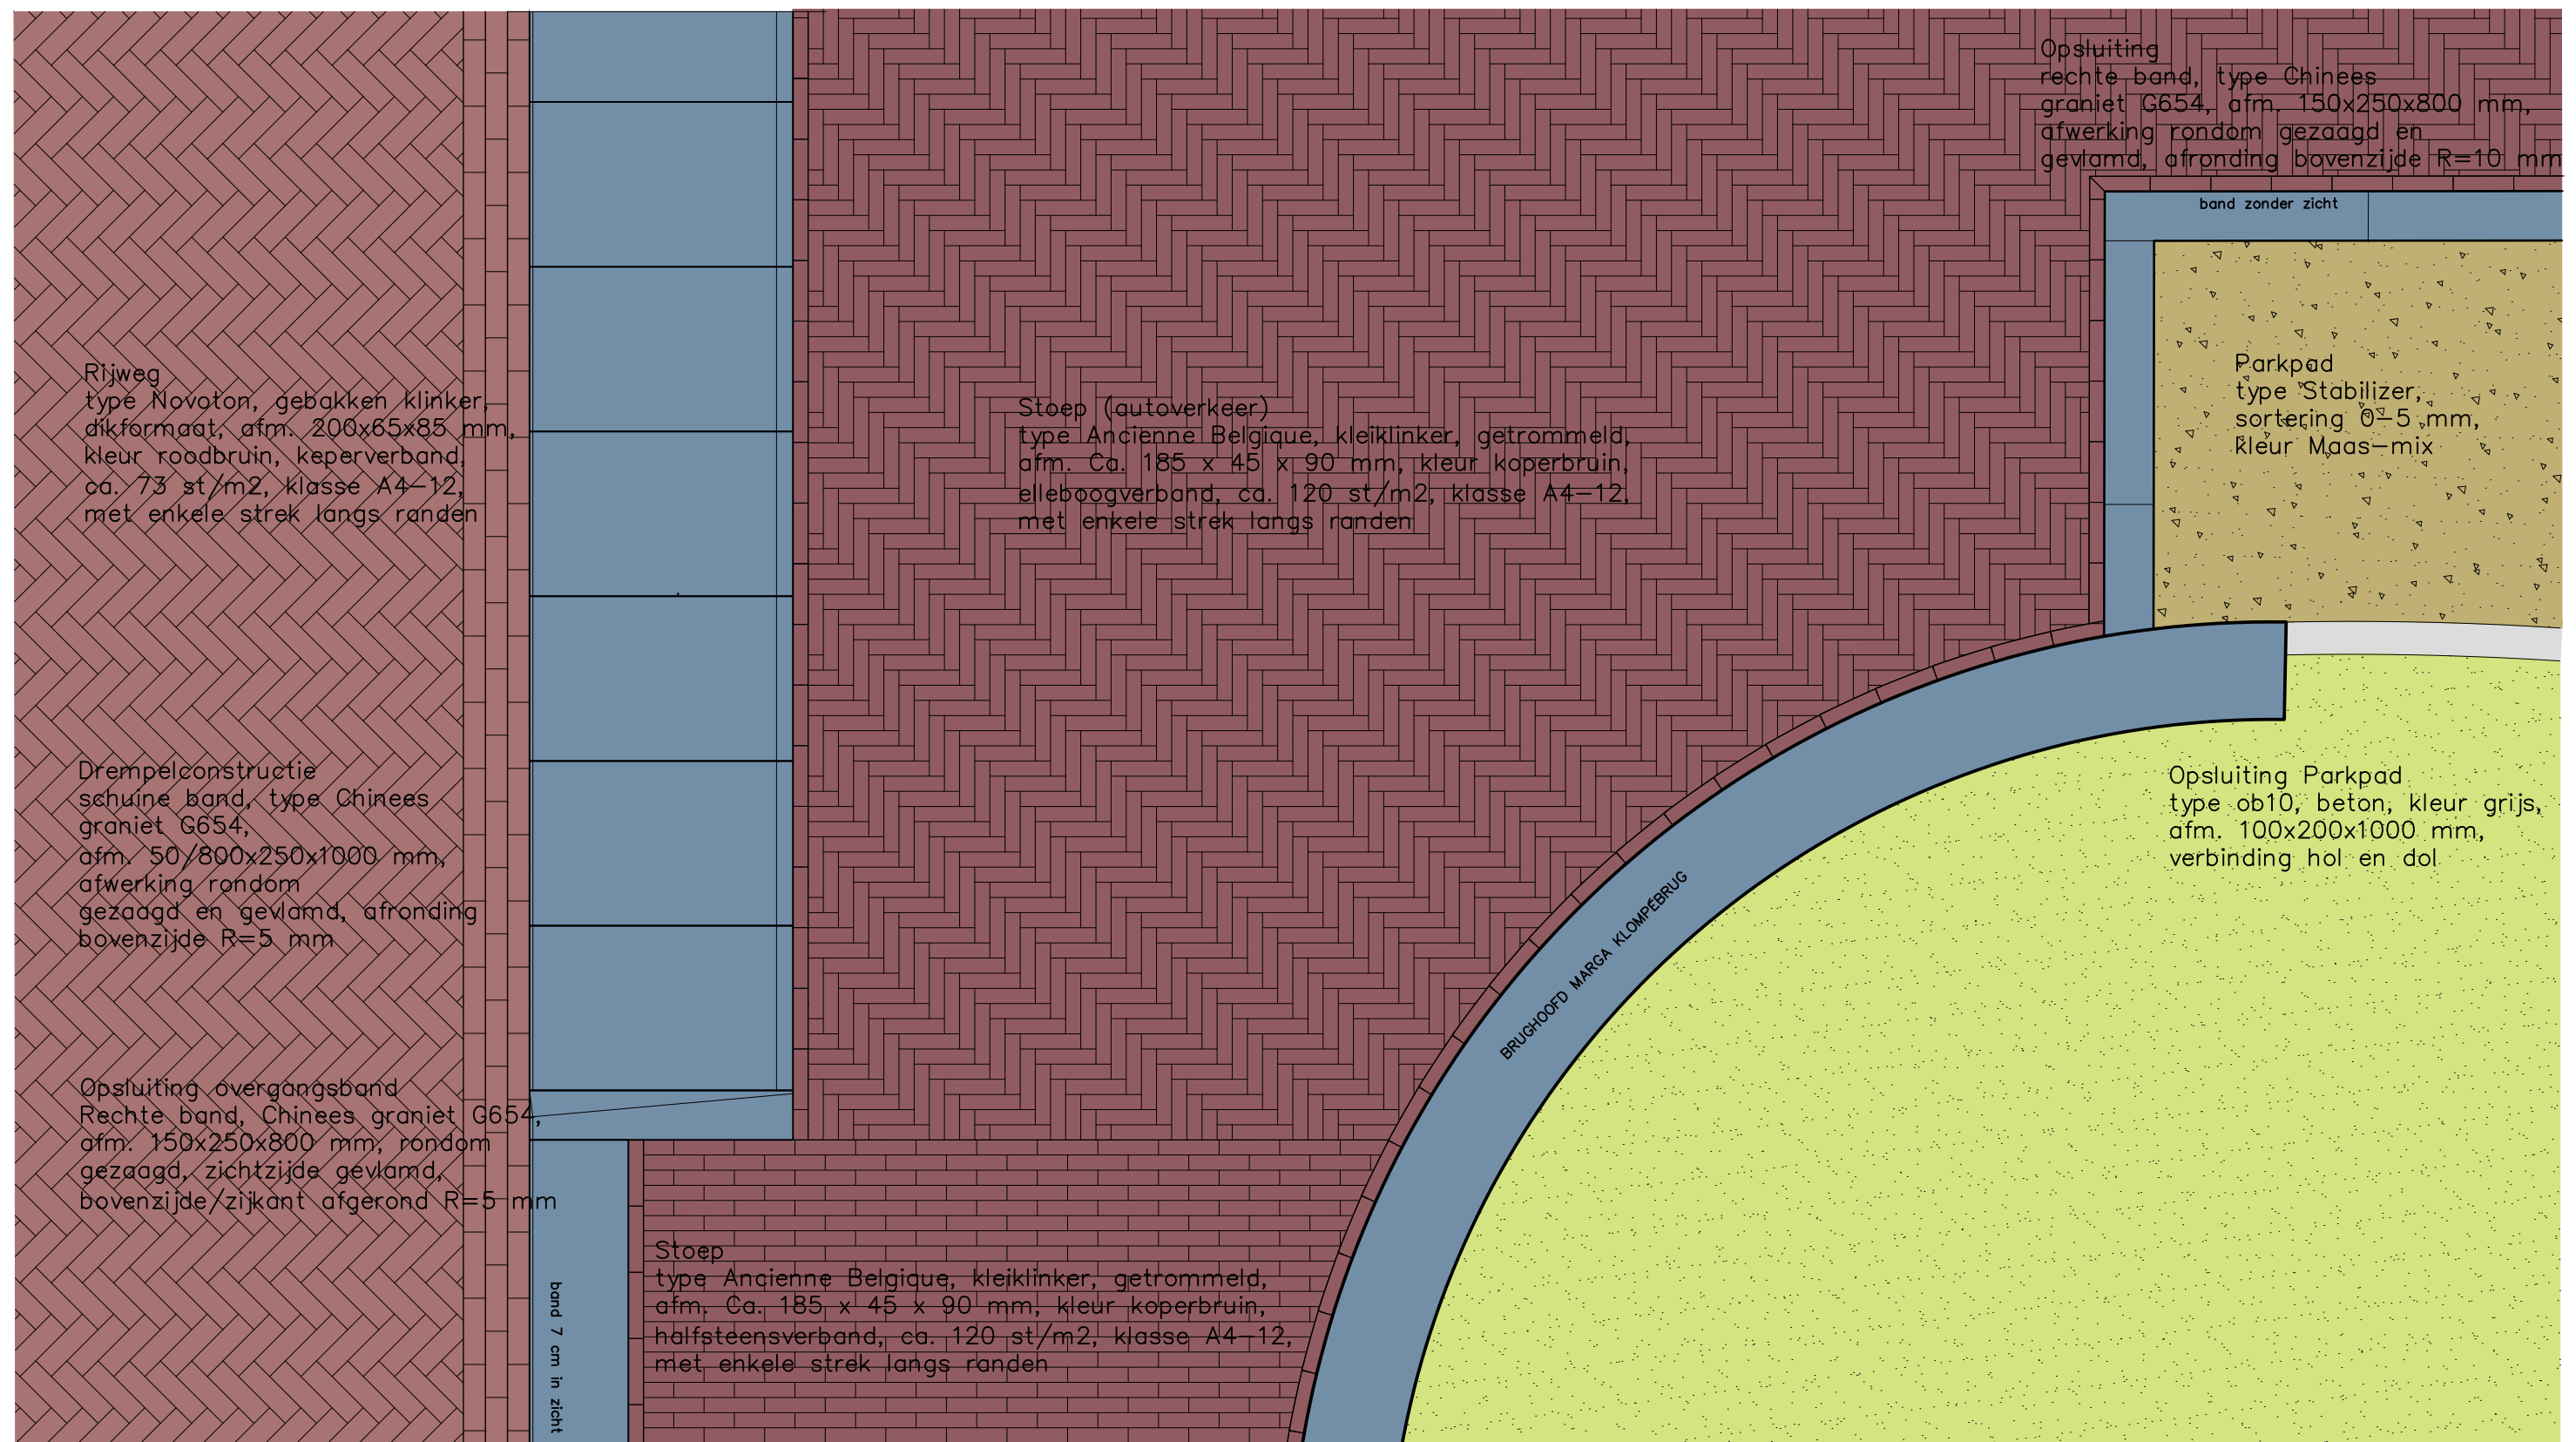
DETAIL WILLEMSPLANTSOEN PLATEAU EN MARKERING BUITENRANDEN STADSMUUR
